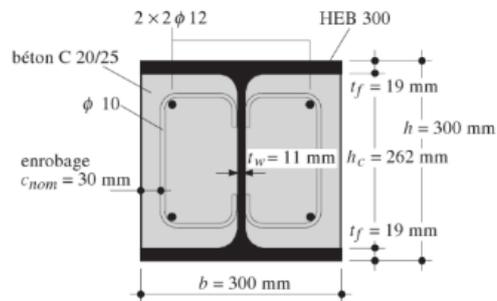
Section transversale du poteau mixte de profilé HEA 300
